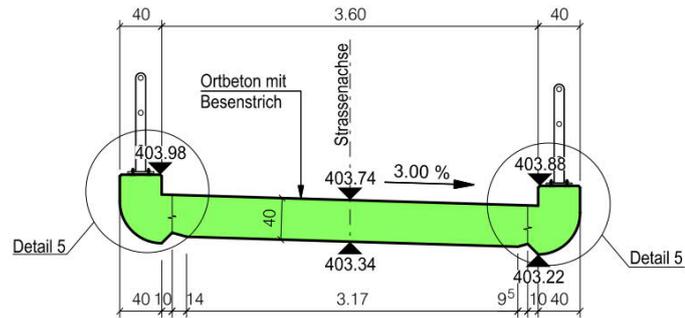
Querschnitt Brücke Wisenstrasse, Äächeli
